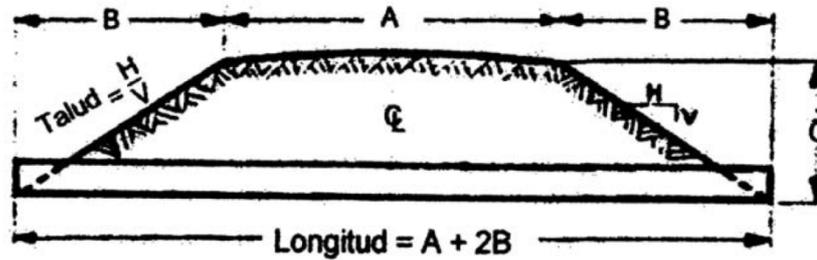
LONGITUD DE LA ALCANTARILLA
